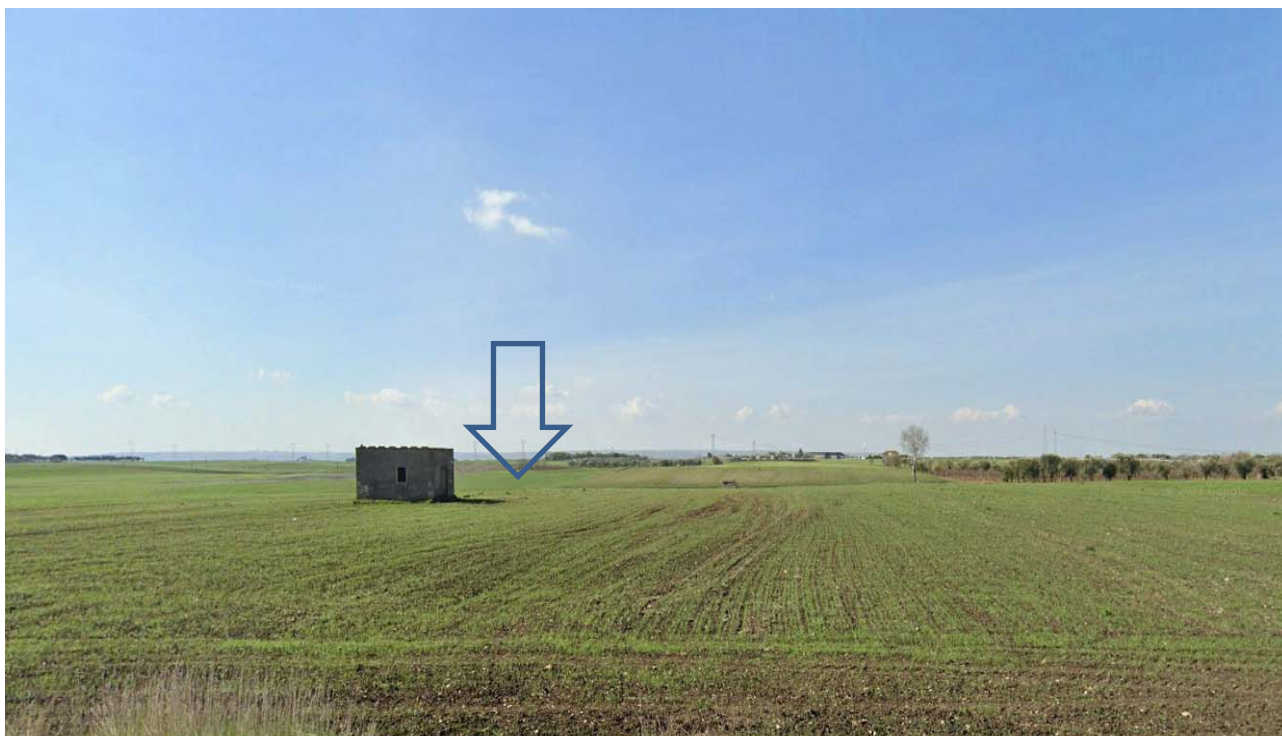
vista campo sud dalla sede tratturale. La freccia indica l'ubicazione dell'impianto in progetto sullo sfondo del fotogramma
